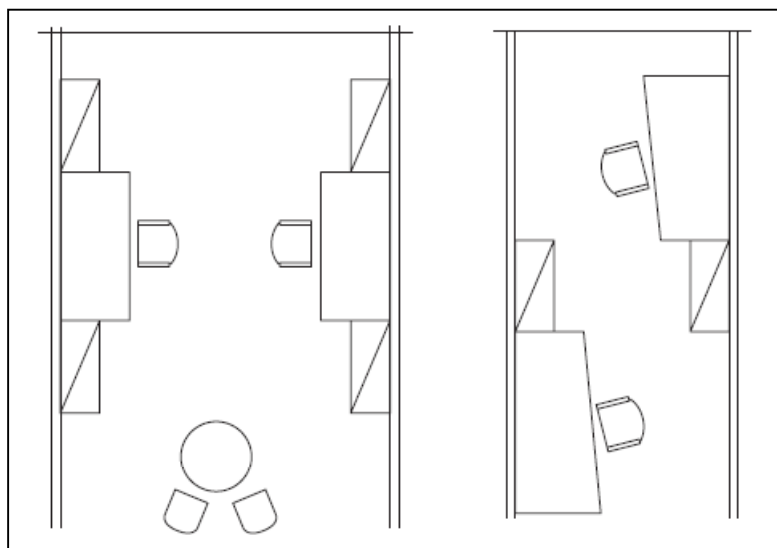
Beispiele für Grundrisse von Zweipersonenbüros mit Orientierung gegen die Wand²³
